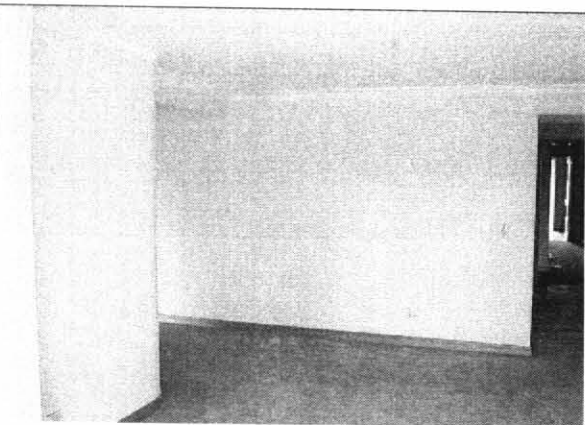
En general, el estado de mantenimiento al interior de los apartamentos es adecuado.
